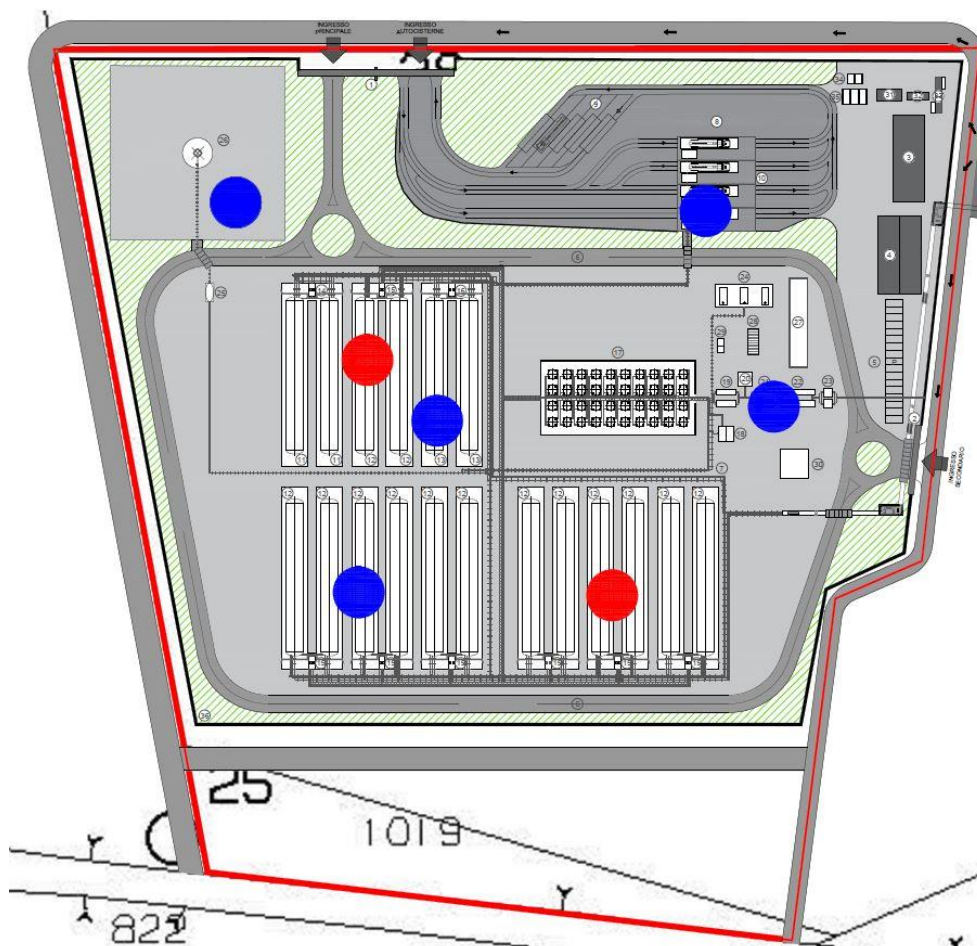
Stralcio della planimetria indagini geognostiche previste.
